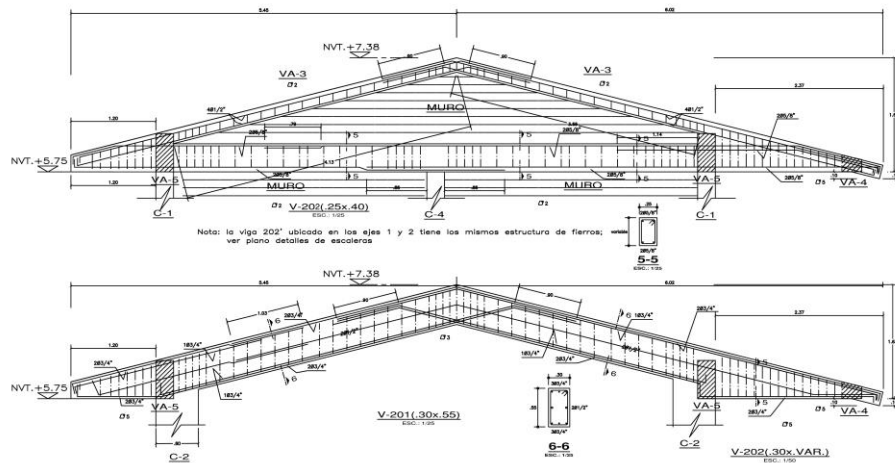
Disposición de las vigas principales del 2do nivel del módulo 780 reforzado.
